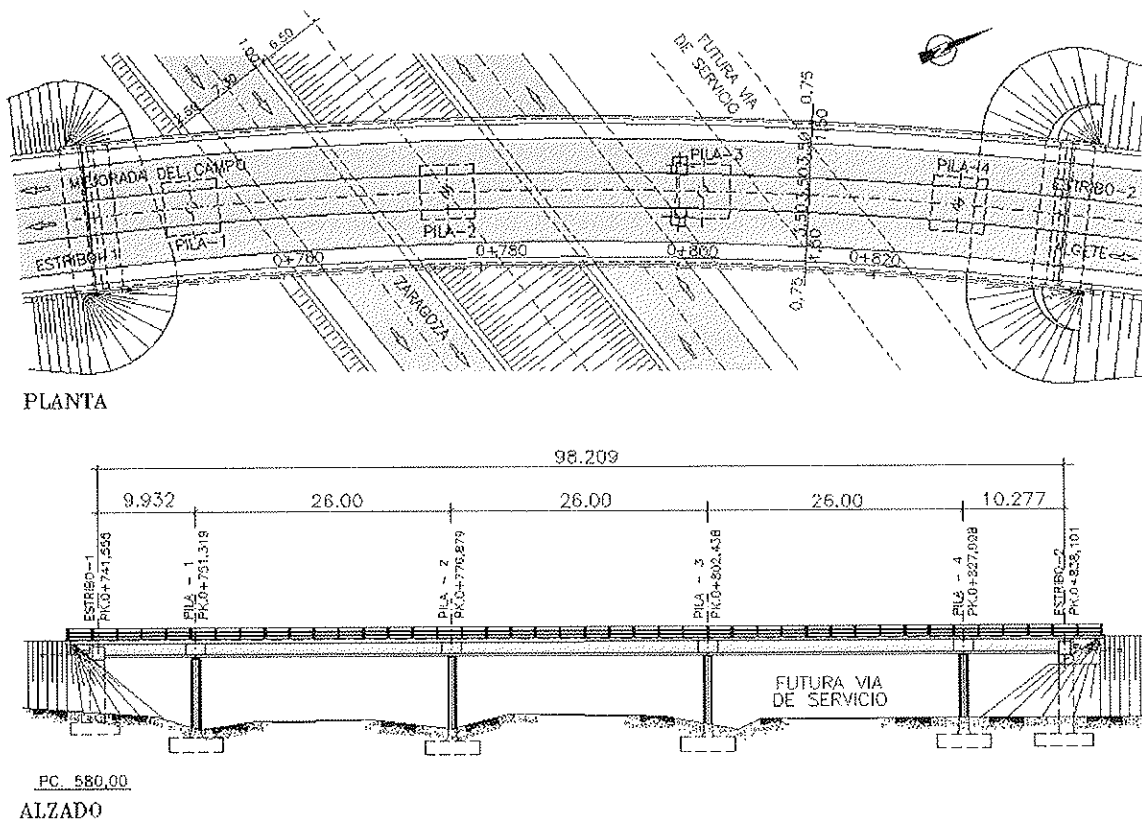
Plano general de la Estructura n.º 3 Planta y Alzado.
